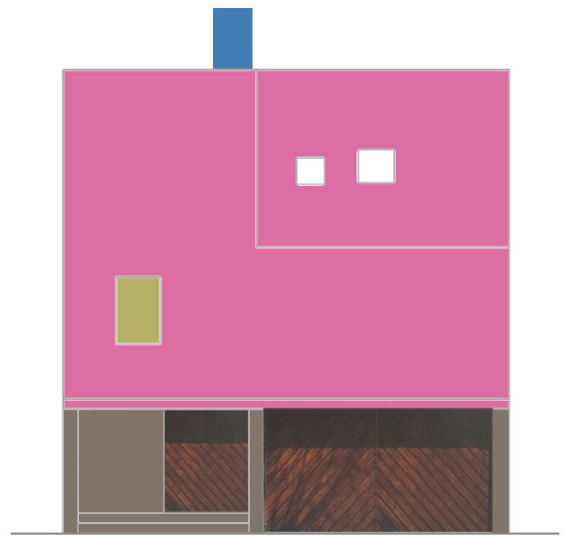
Alzado fachada principal Casa Gilardi. Elaboración propia.
